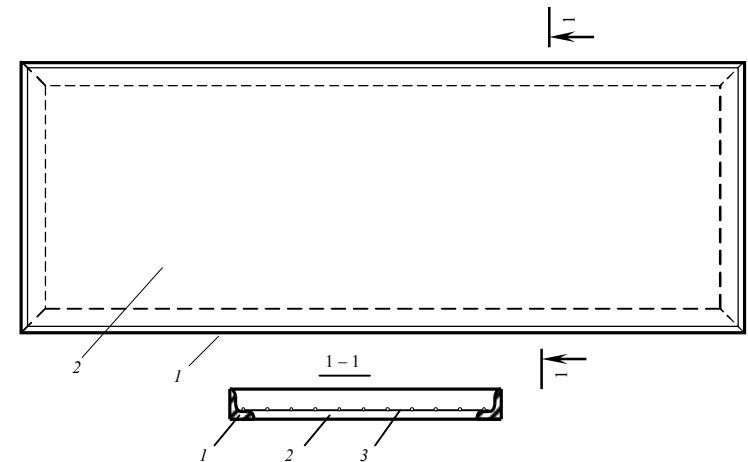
Схема залізобетонної плити зі сталевим обрамленням
